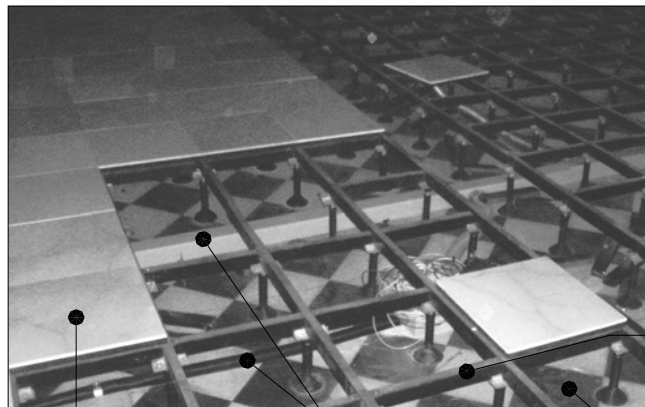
NIVEL DE PISO ELEVADO PARA FACILITAR INSTALACIONES. se propone mantener el nivel de piso actual (+0.30Mt.). El propósito es utilizar este espacio para la distribución y conducción de instalaciones, tanto eléctricas, como de aire acondicionado, telefonía e internet.
